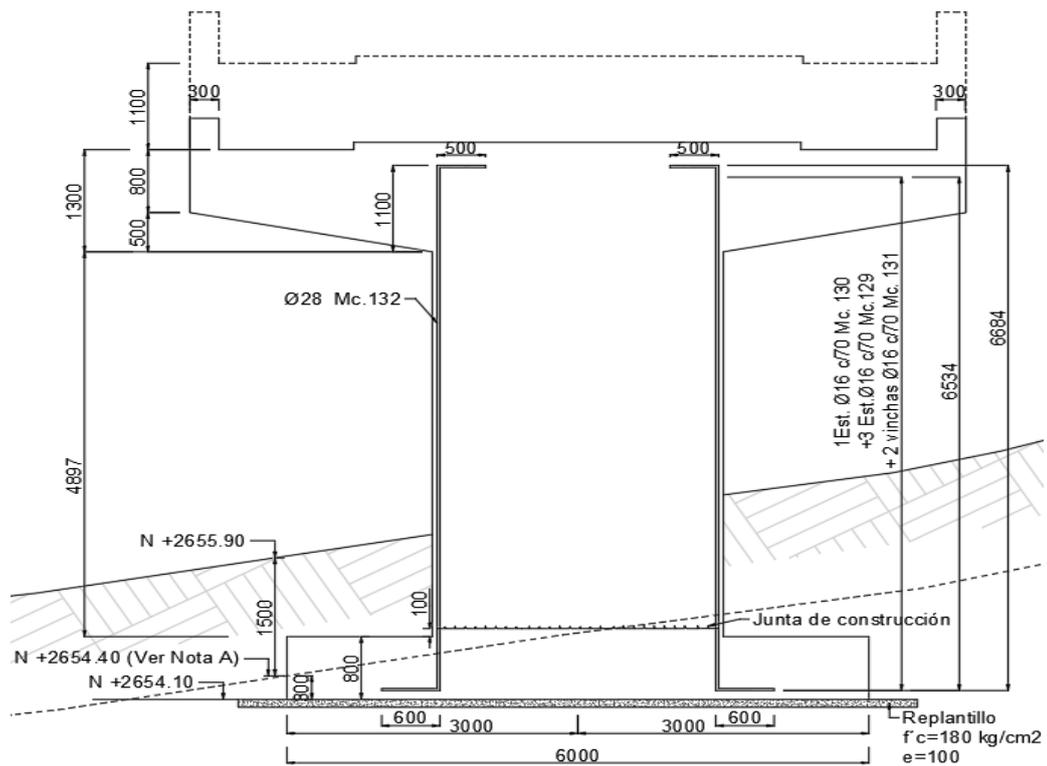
Armado pila 2 [Elaboración propia]
